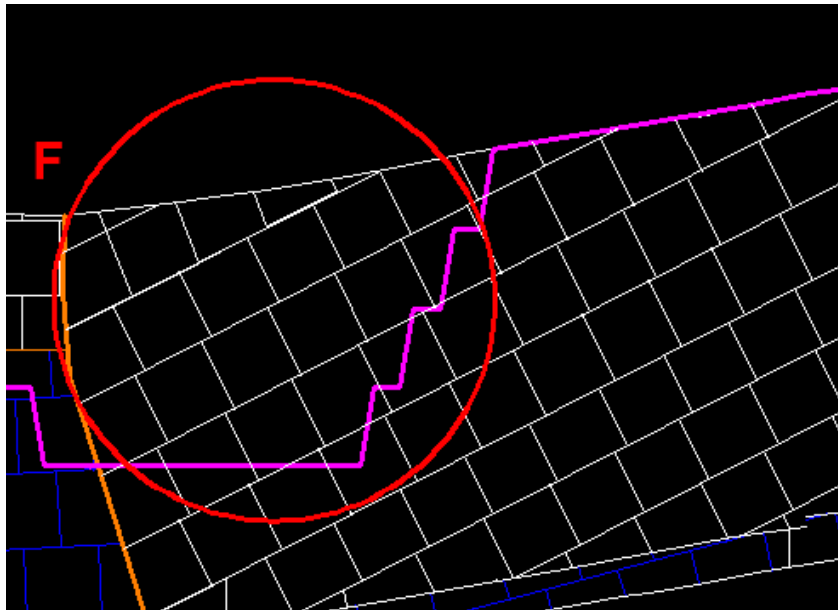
l'implantation des gradins à l'aide du plan d'exploitation sur la coupe VI-VI'
